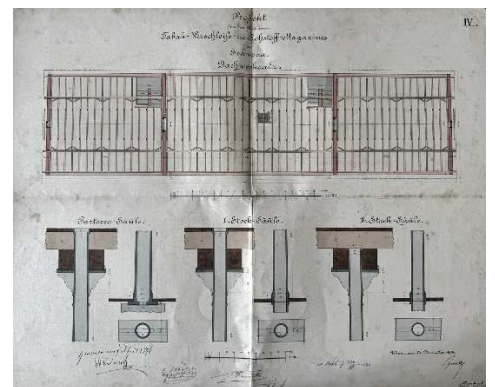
Grundriss, Lager in Gruž, Dubrovnik., Säulen, Architekturplan, 1896.
